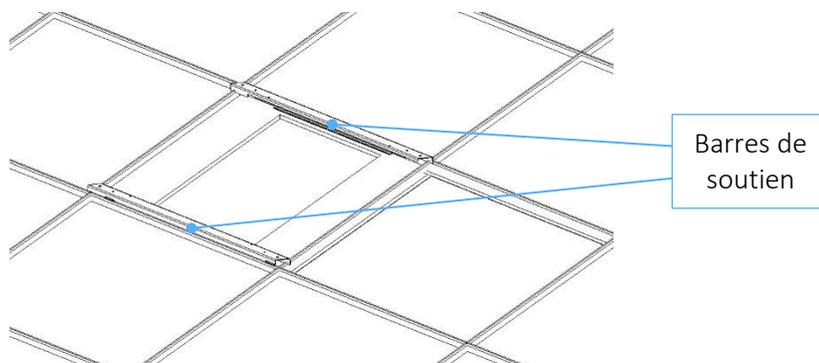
Fixation faux plafond 60x60: passage C.
